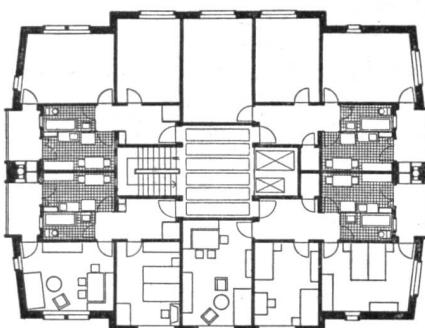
Obergeschoß-Grundriss der Basler Hochhäuser. Turmhochhaus mit konzentrisch um die Treppenanlage angeordneten Wohnungen. Maßstab 1 : 400.
